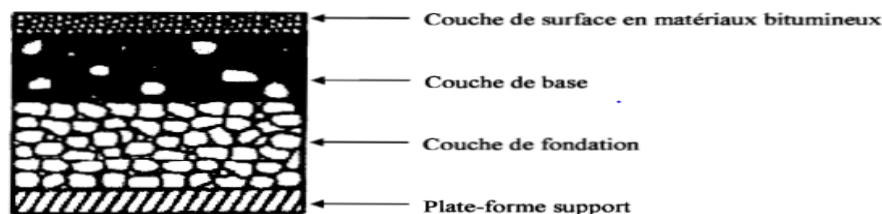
Schéma conceptuel du fonctionnement d'une chaussée souple (Coupe transversale d'une chaussée souple adapté de Bessahraoui & Bentría (2015-2016))
